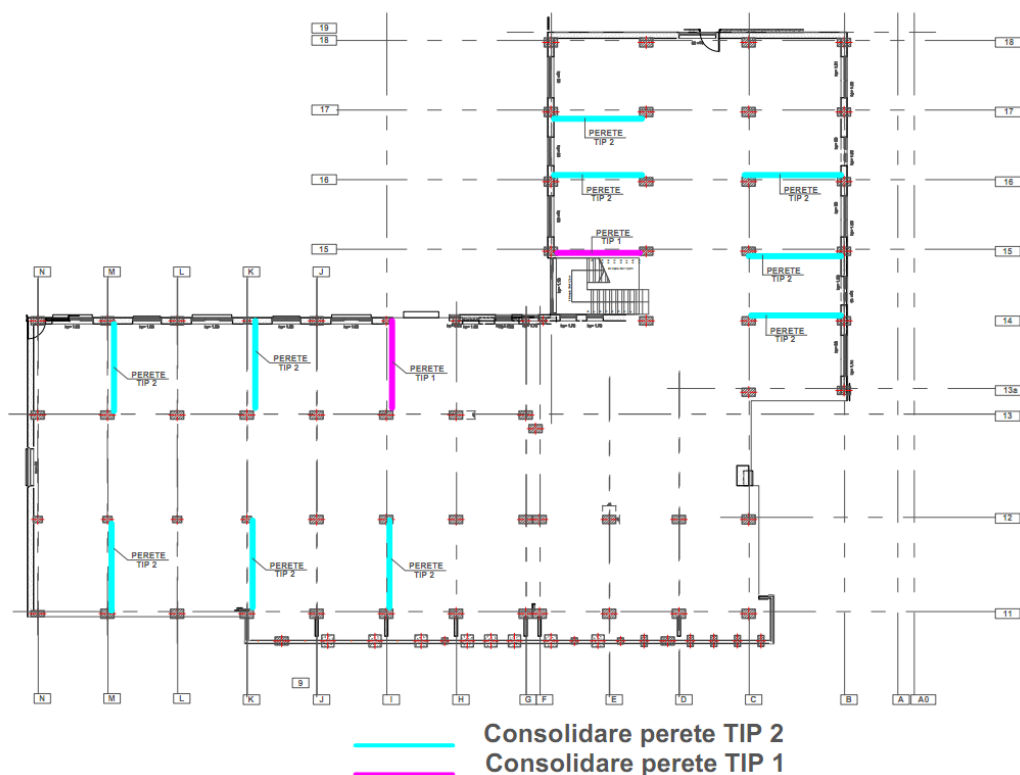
Plan de consolidare propus pentru etajele 2-7
